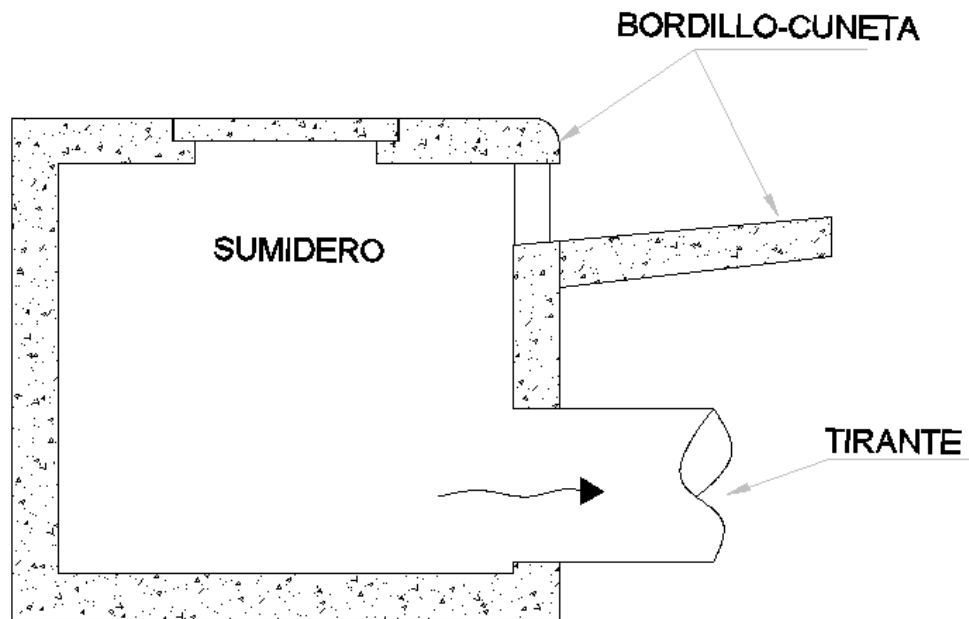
Componentes de un sistema de alcantarillado pluvial (1)
